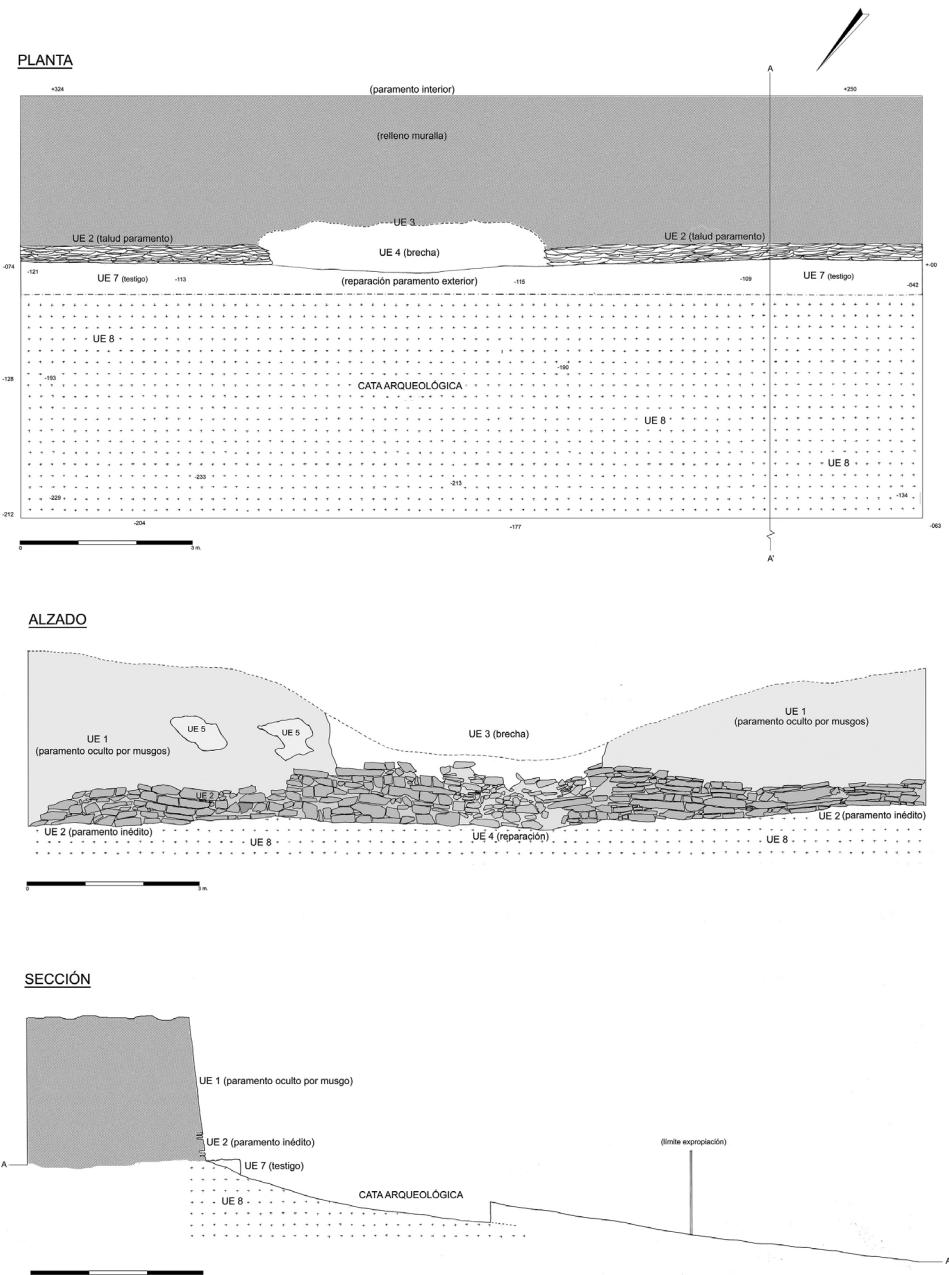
Planta, alzado y sección de la cata efectuada en el pasillo paralelo al paramento exterior de la muralla, en la zona del inicio del parking.
